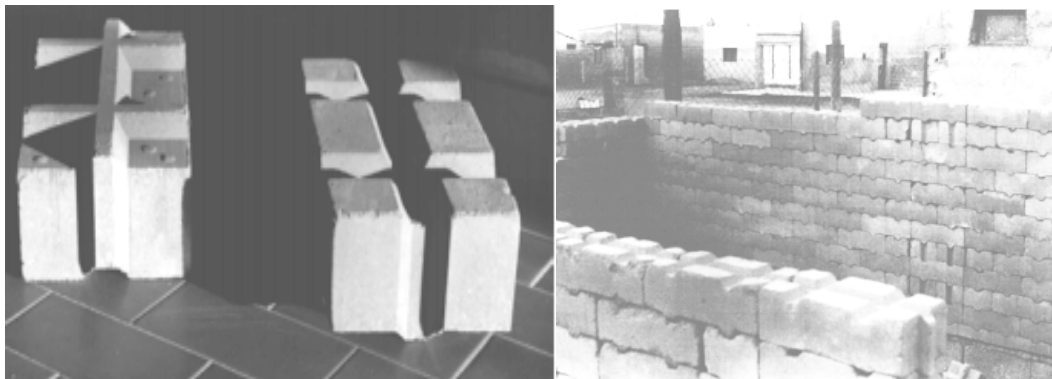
Machimbloques empleados en el proyecto “El Hornero”.
